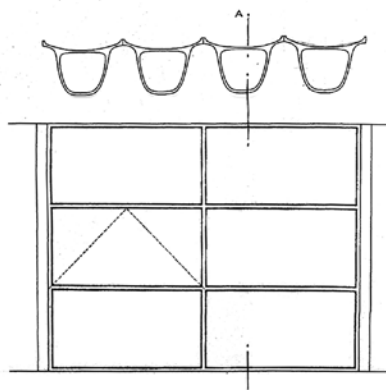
Instituto Núñez de Arce. Detalle constructivo.
